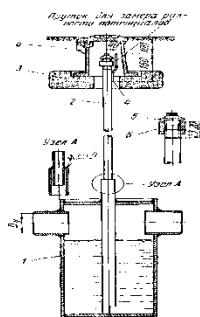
Конденсатосборник низкого давления: 1 – корпус; 2 – трубка; 3 – подушка под ковер; 4 – ковер малый; 5 – пробка; 6 – муфта.
